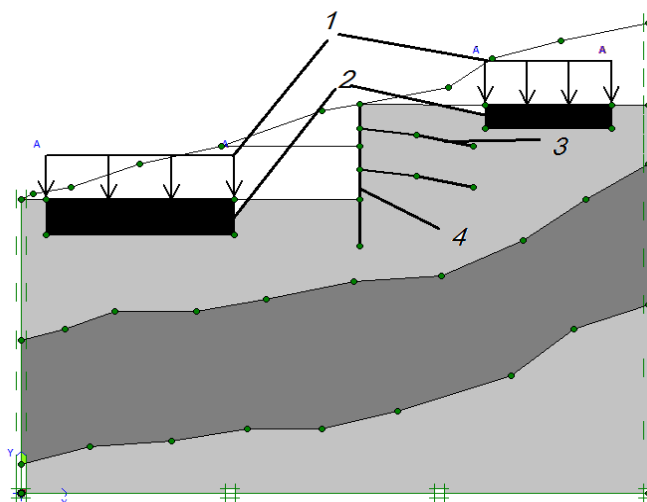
Расчетная схема с фундаментами запроектированных сооружений (2) и нагрузками (1) от собственного веса на примере шпунтовой (4,) заанкеренной (3) подпорной стенки (вариант а+б).
